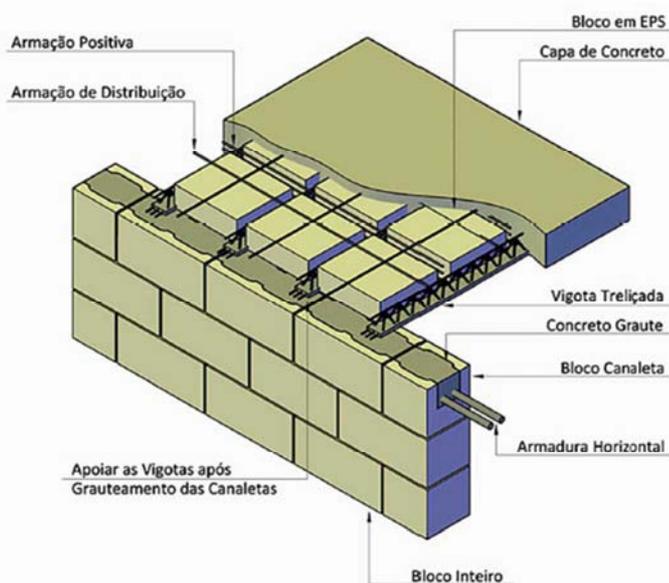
Esquema de fabricação de laje com vigotas treliçadas e caixões perdidos em EPS
